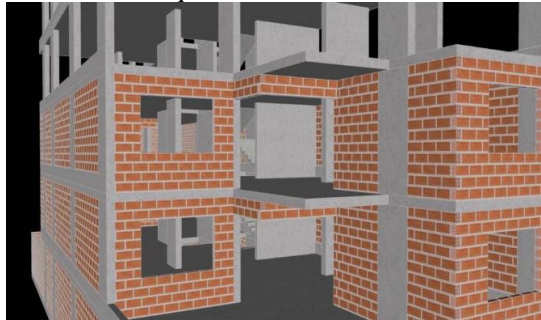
Mampostería de muro confinado (QUIROGA, 2023)
